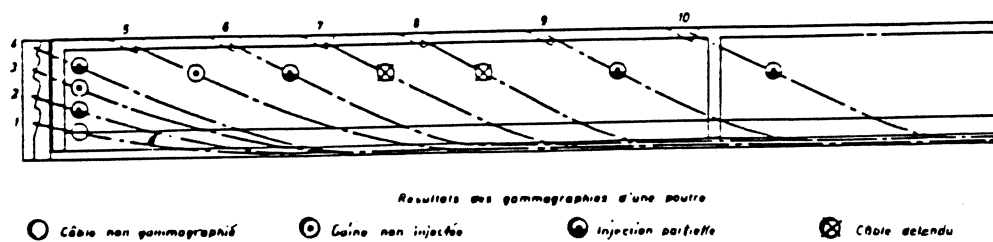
Brücke Val d'Azergues, Längsschnitt durch Spannbeton-
